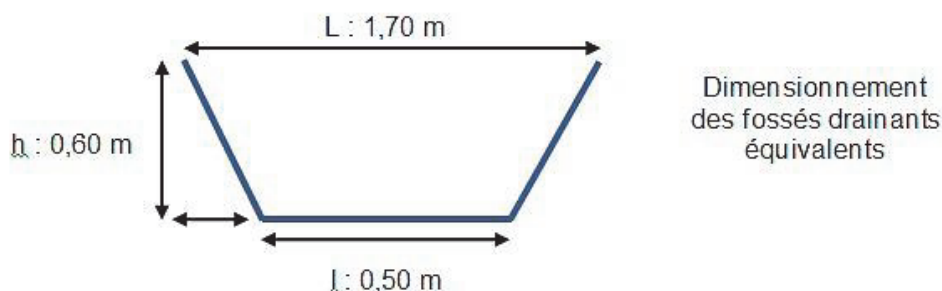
Coupe type du dispositif des fossés drainants équivalents.
